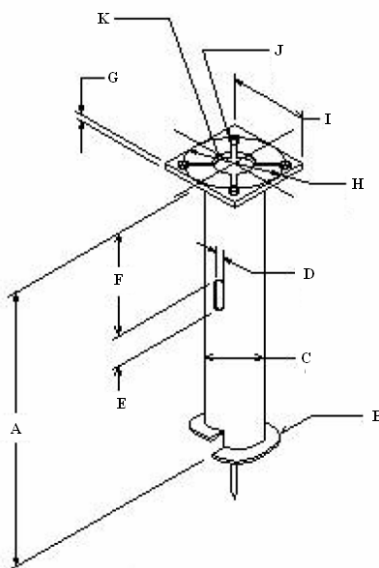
Sekcje czołowe i przedłużające dla gwoździ SOIL SCREW
